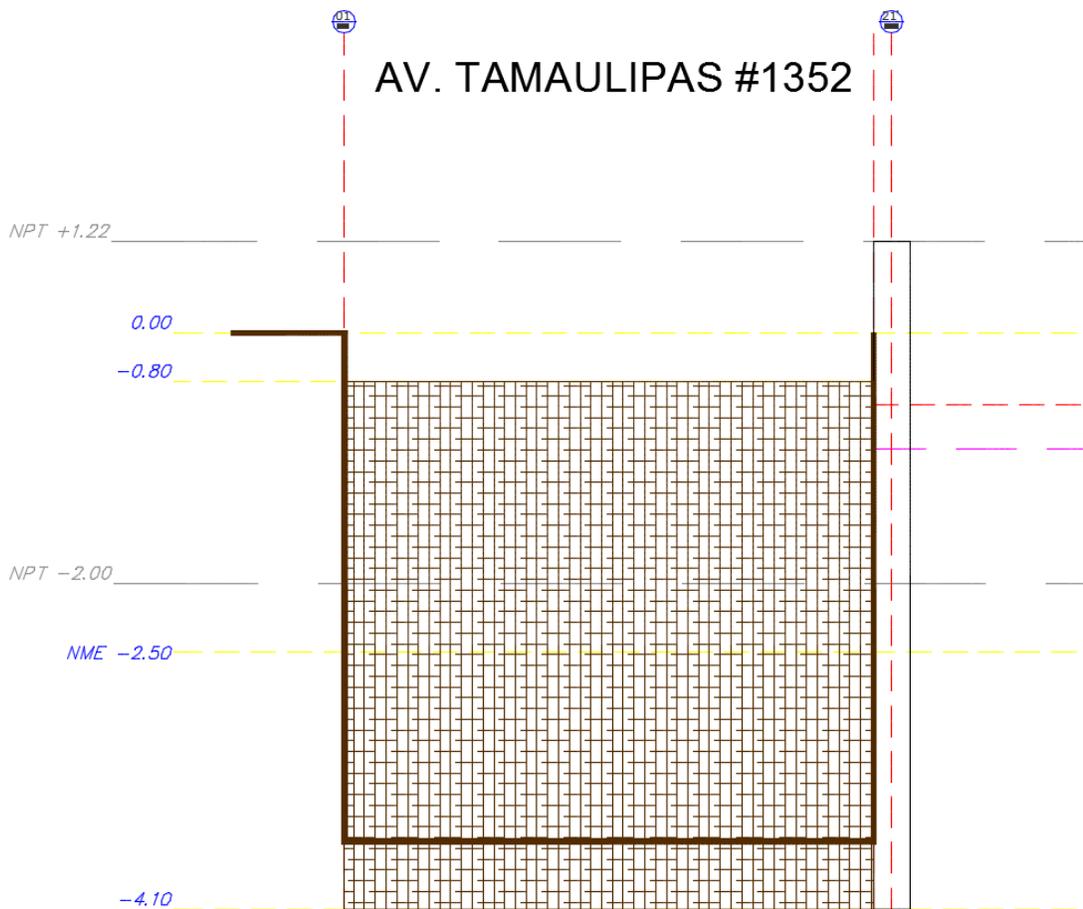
COLOCACIÓN DE VIGUETAS.
